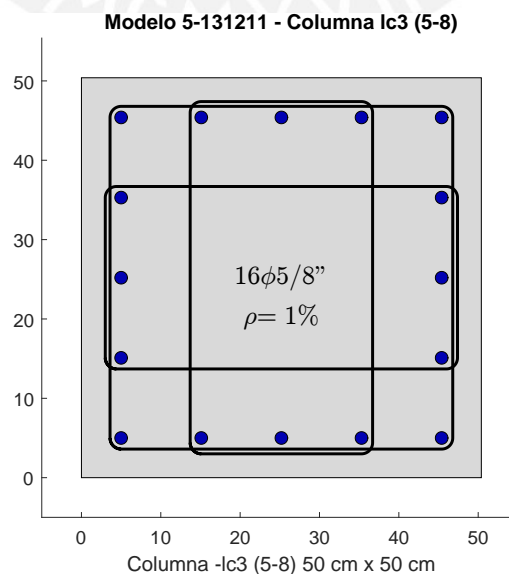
Sección resultante del diseño para columnas de concreto armado.
